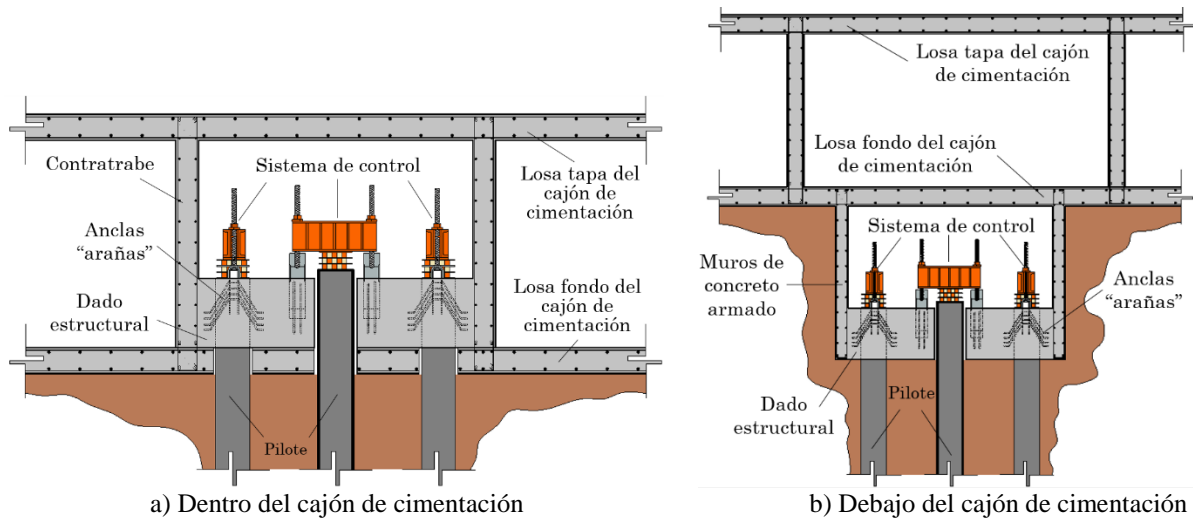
Ubicación de los sistemas de control (modificado de PICOSA, 2014).
